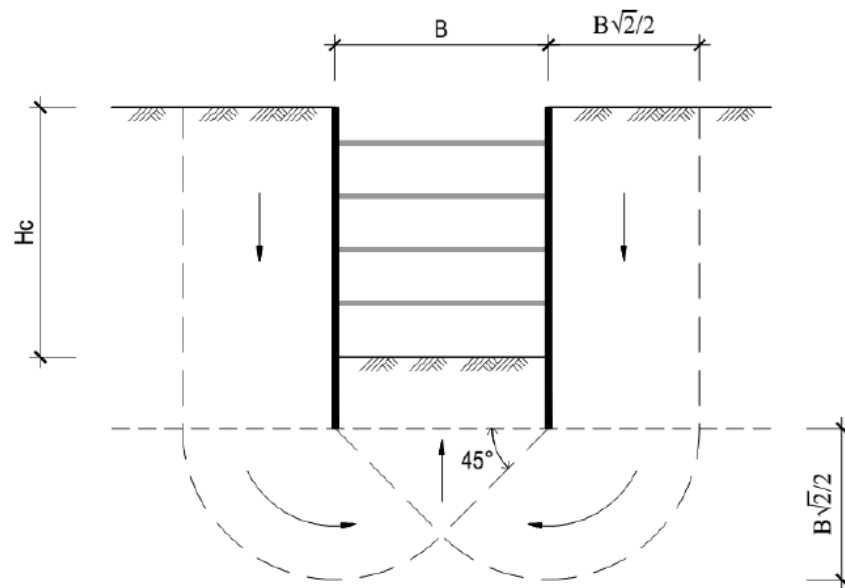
Mécanisme de rupture de la fondation d'une excavation
